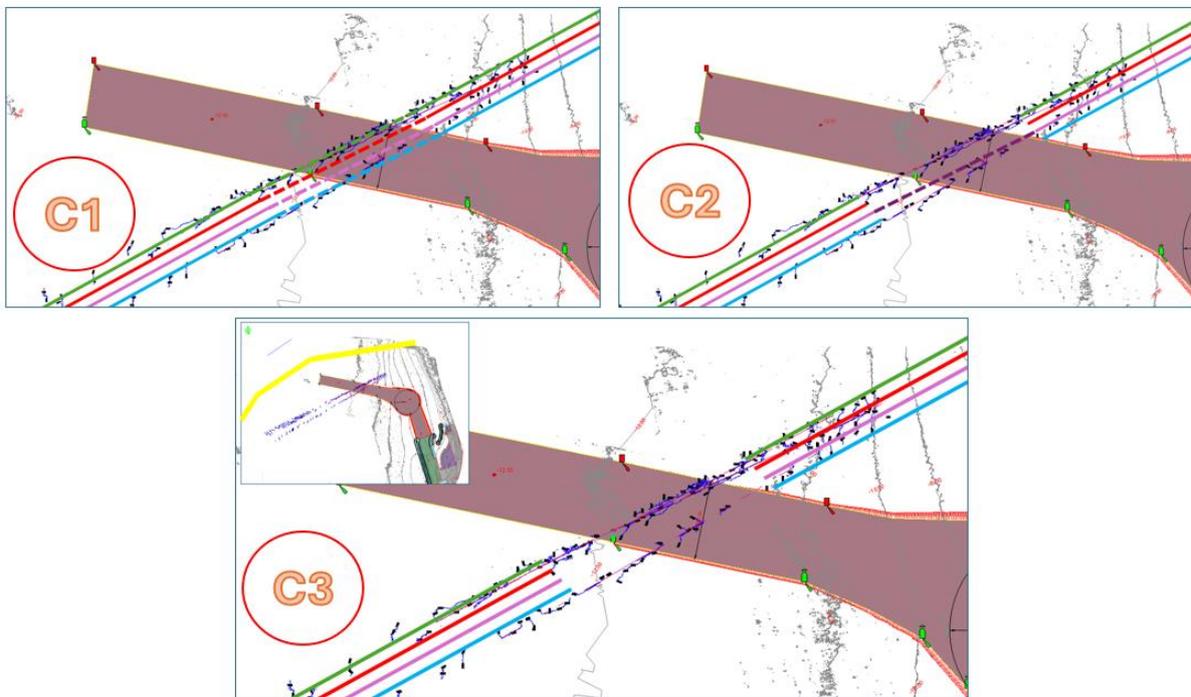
Rappresentazione schematica delle alternative C1, C2 e C3
